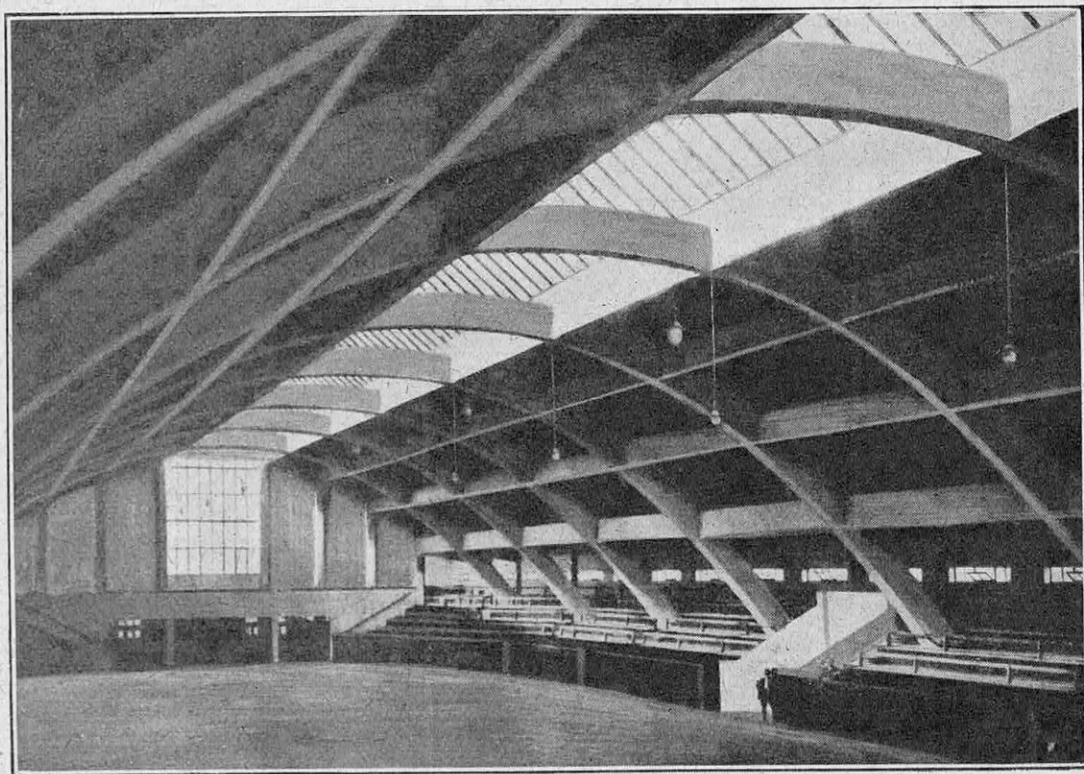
VUE INTÉRIEURE DU HALL DU MARCHÉ AUX BESTIAUX DE MAGDEBOURG (ALLEMAGNE) ENTIÈREMENT CONSTRUIT EN BÉTON ARMÉ
